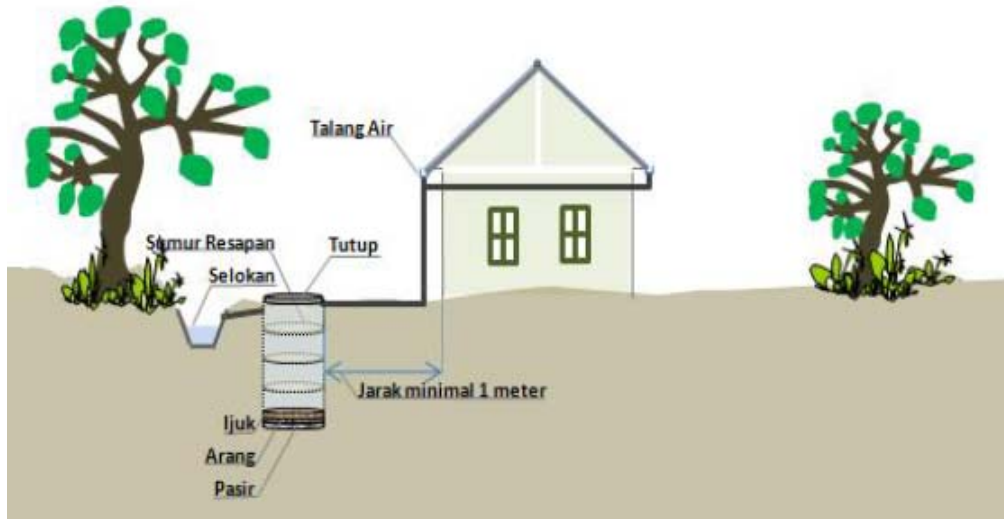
Instalasi pemanenan air hujan (Permen LH No. 12 Tahun 2009)
